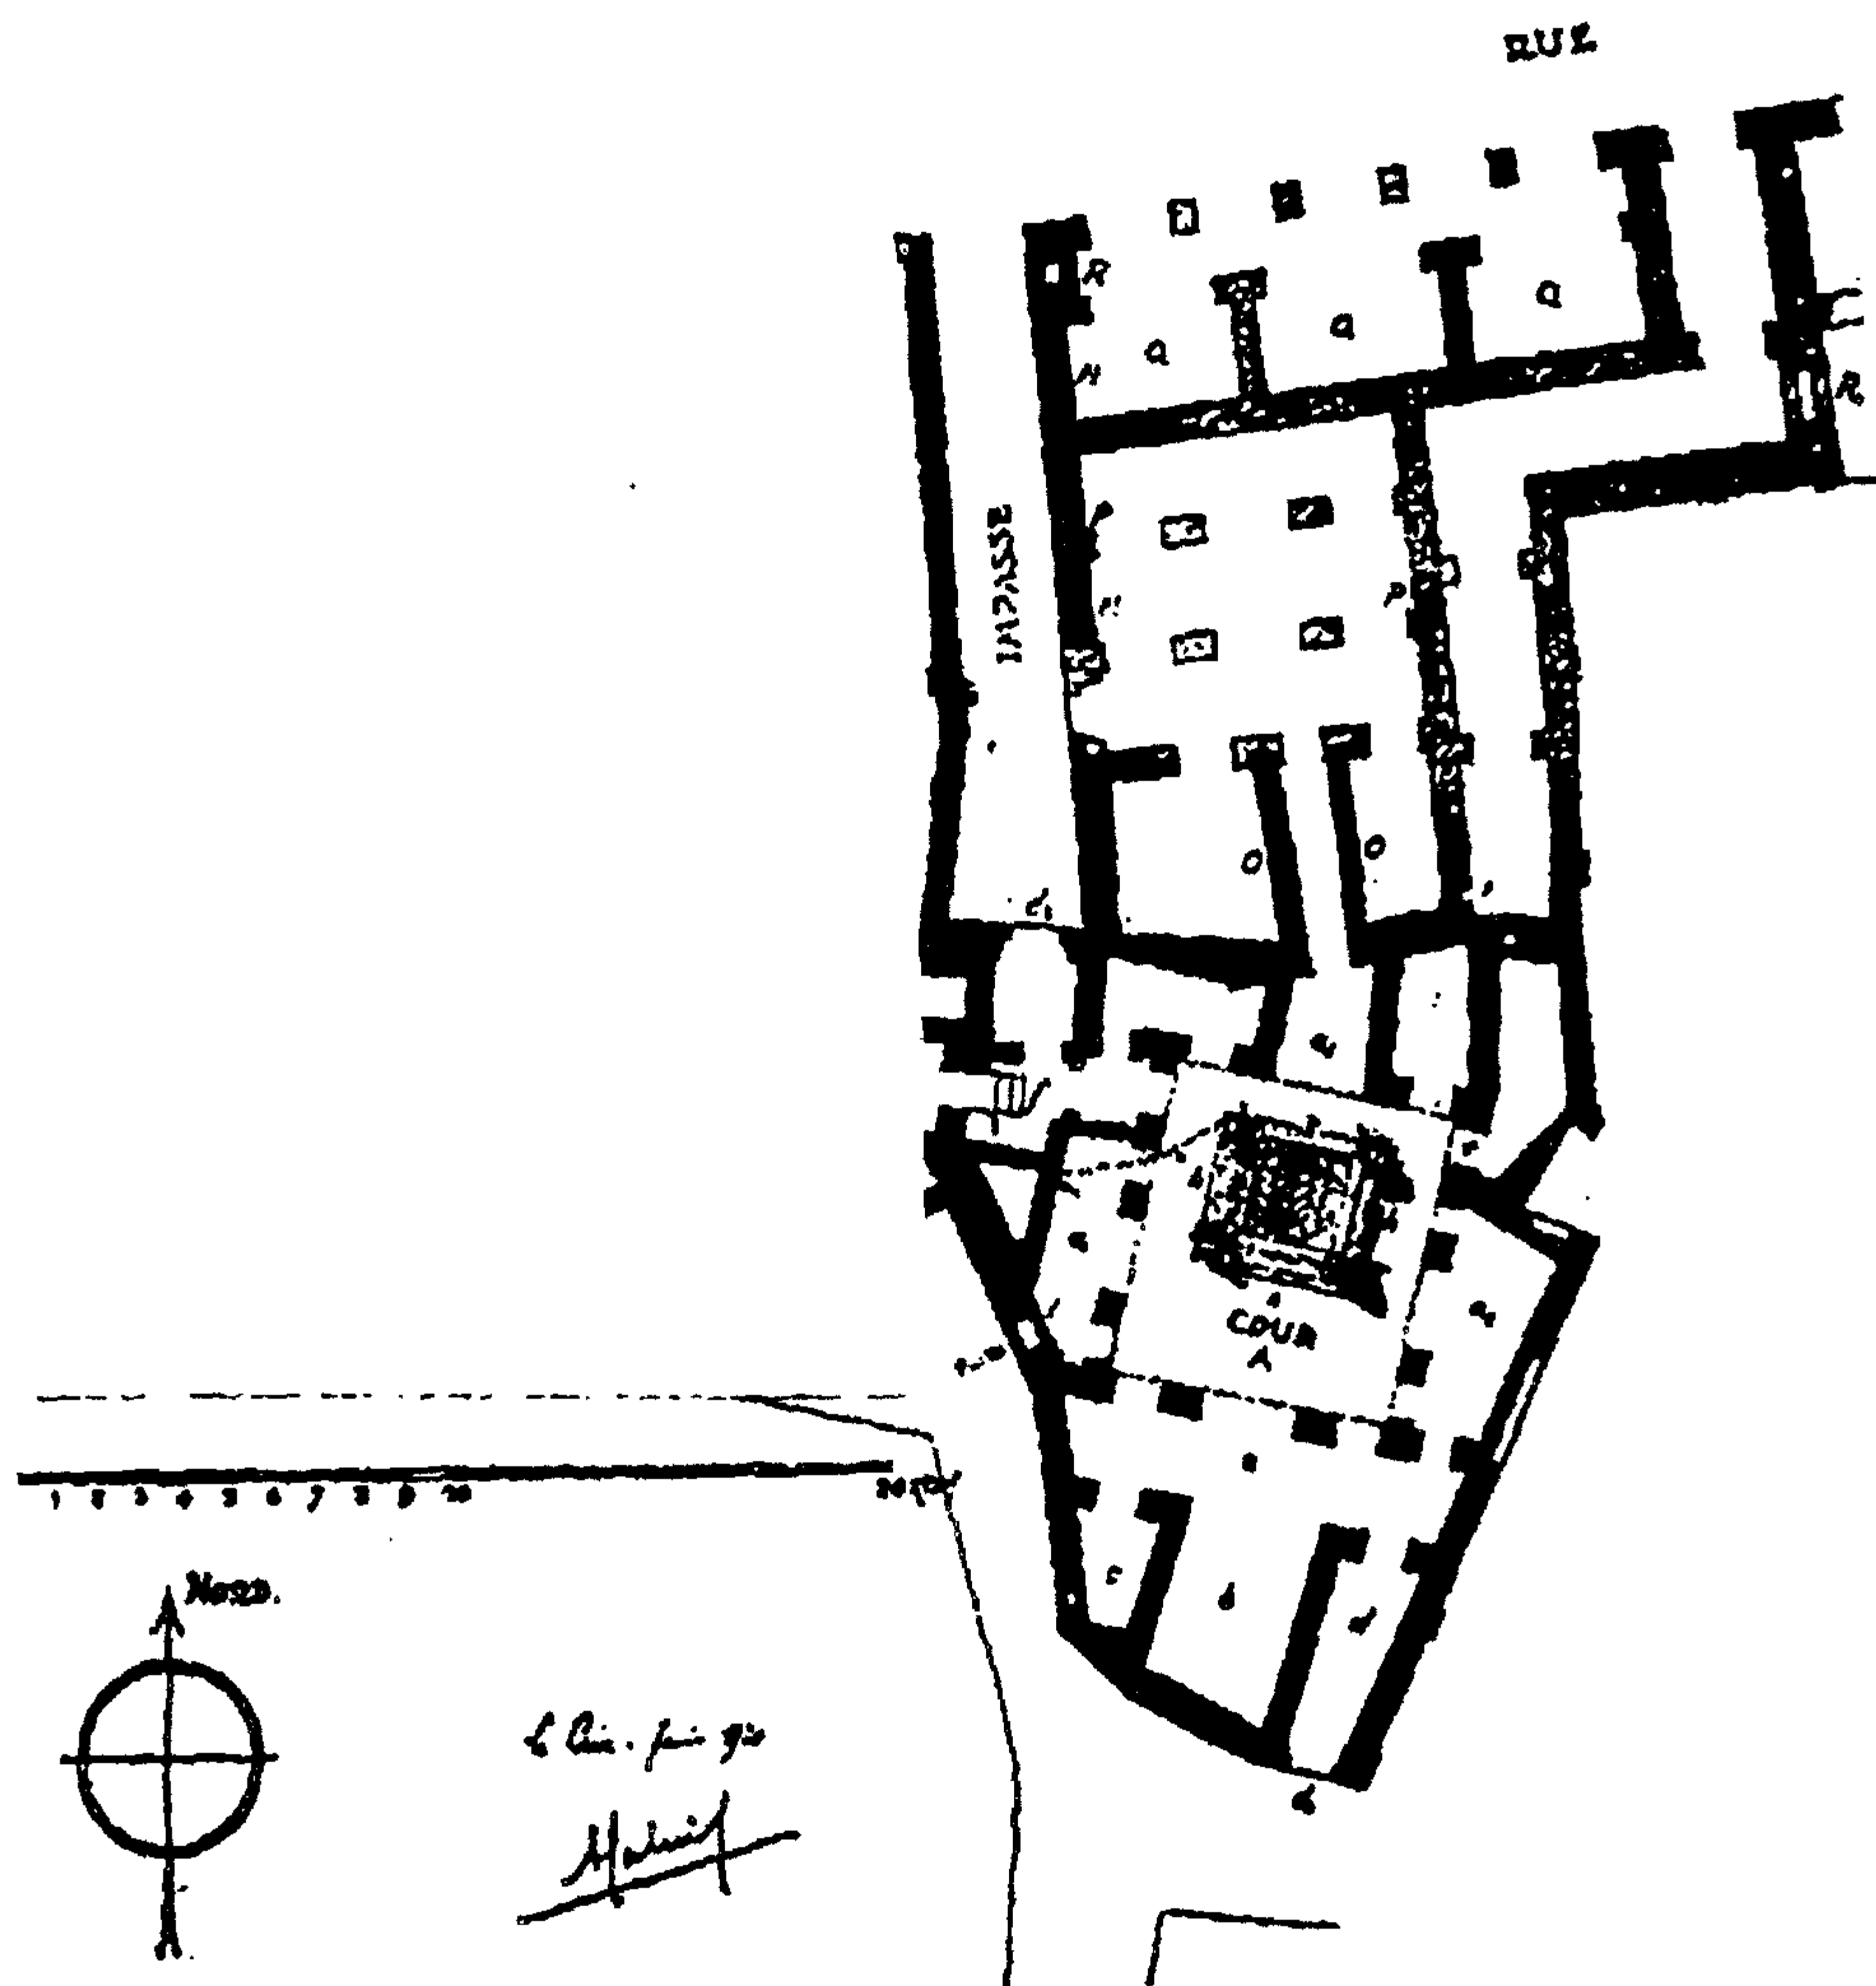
مسقط أفقي لمنازل القسطاط . (الدار الأولى) .
